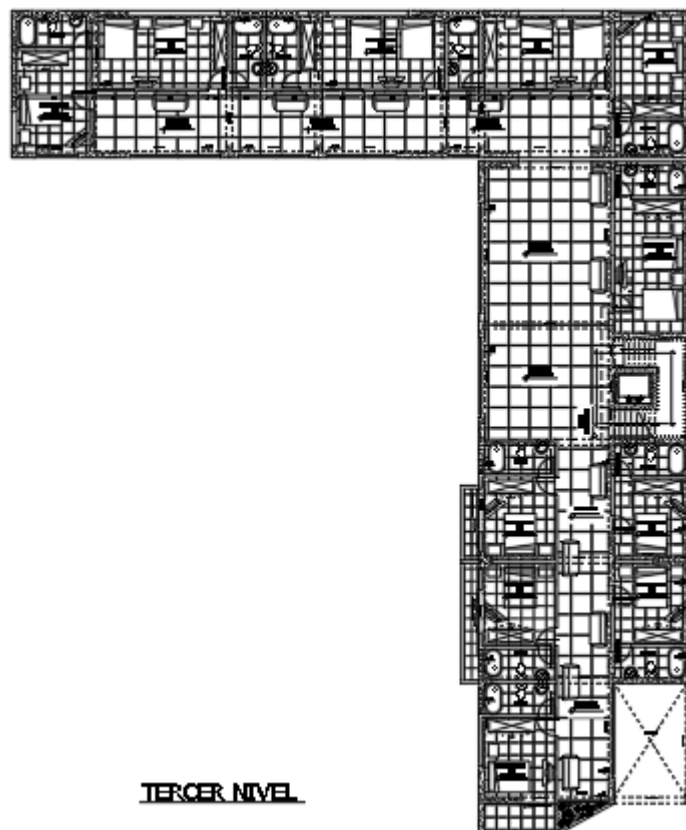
Plano en Planta Tercer Nivel del Hotel.
